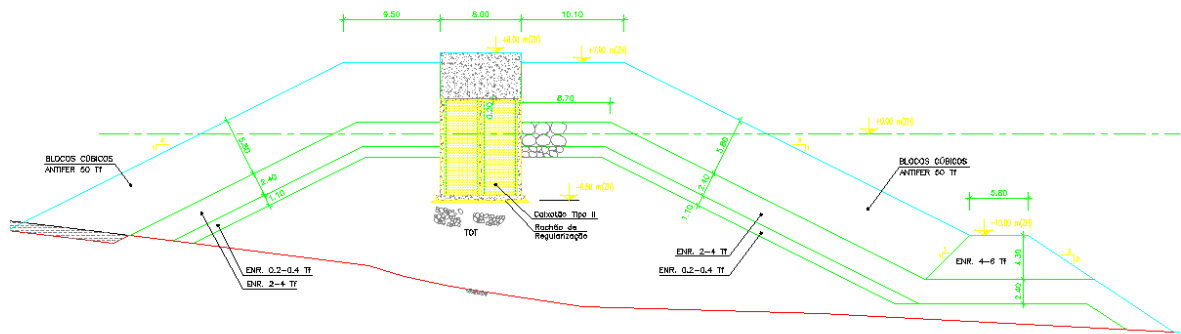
Perfil transversal, corte 3 – 3. [1]
